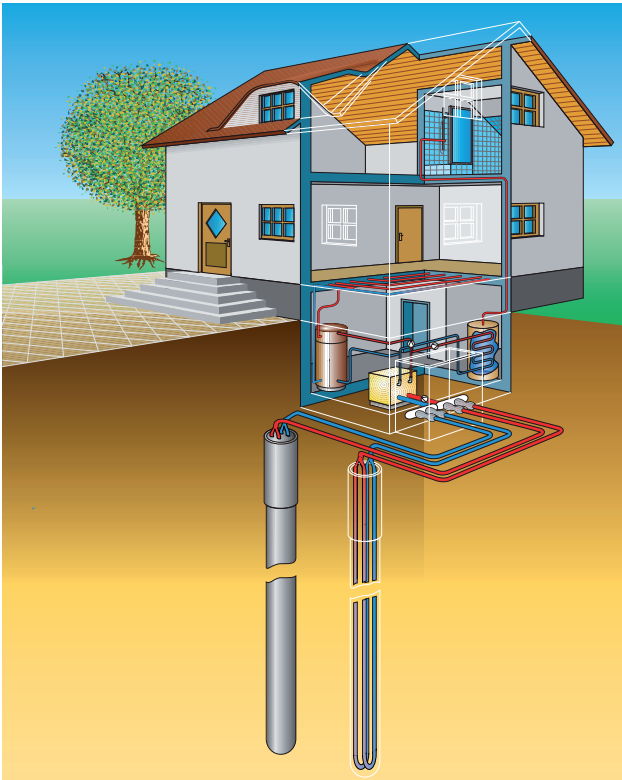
Erdreich Wärmepumpe mit Sondenanlage
